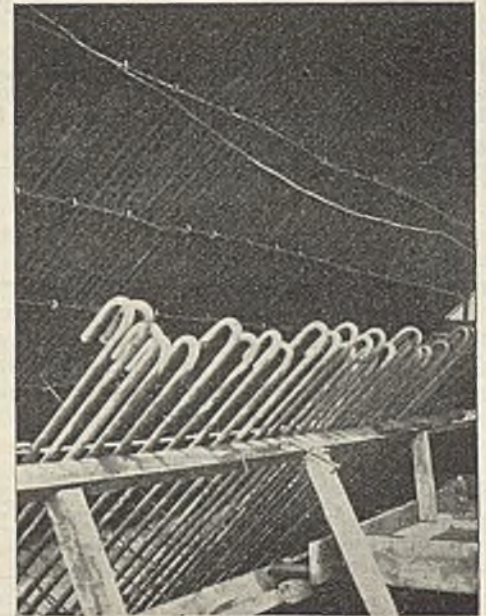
Bewehrung am oberen Teil des Widerlagers.
